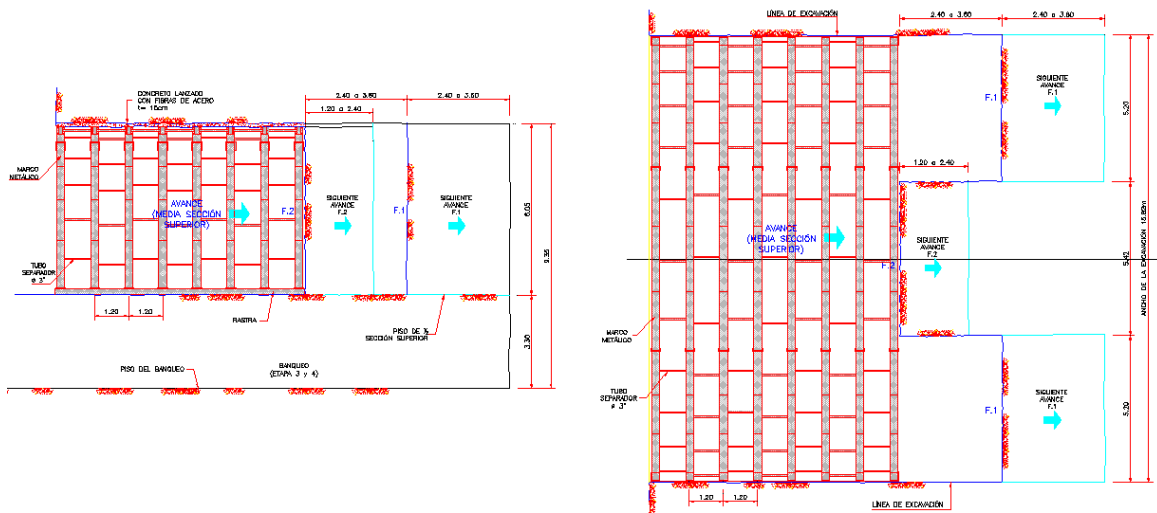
Perfiles y plantas de excavación en Condición Geotécnica “D⁽⁺⁾”
